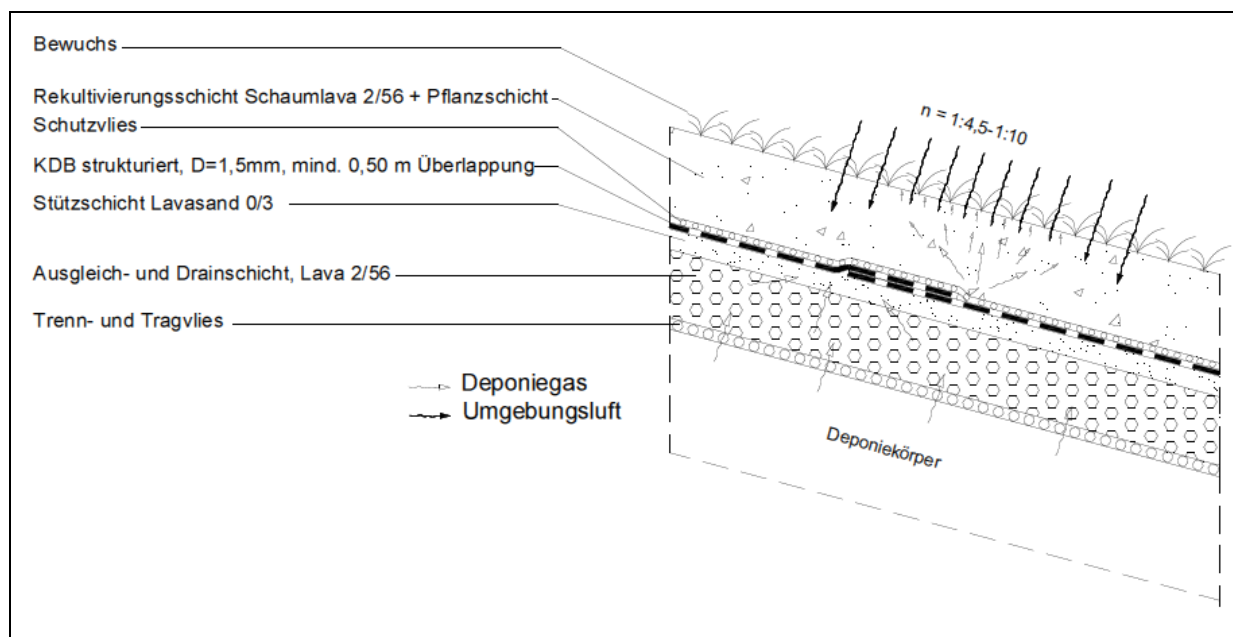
Aufbau einer temporären Oberflächenabdeckung mit Rekultivierungsschicht zur Methanoxidation (Rettenberger, 2006)
